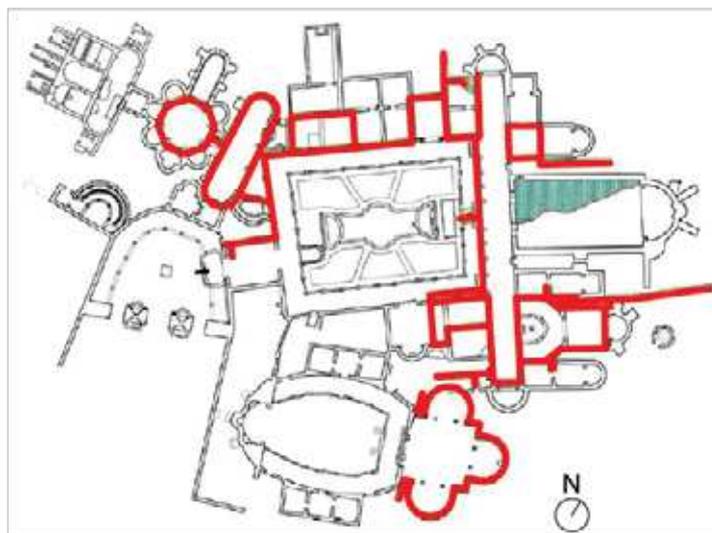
Pianta di Villa del Casale con evidenziazione delle passerelle installate sulle creste delle murature.
